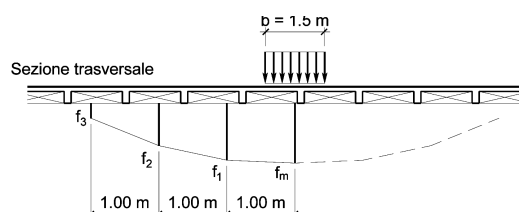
Posizionamento trasversale dei flessimetri. Transversal placement of deflectionmeters. (Sezione trasversale: transversal section).
